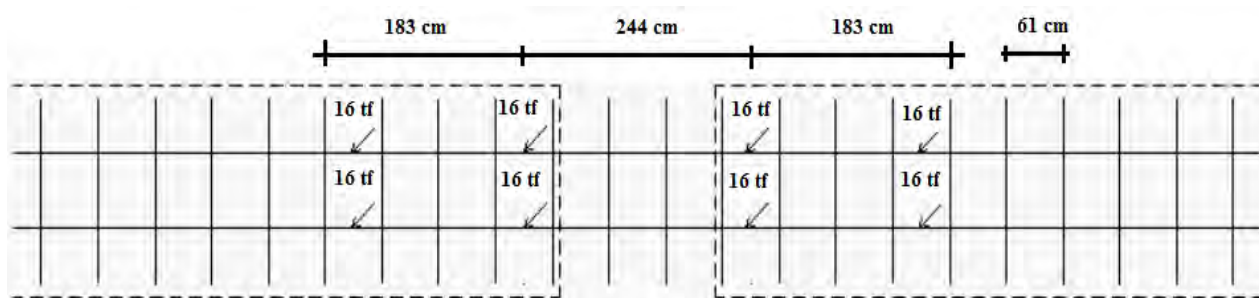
Esquema em planta de 2 vagões GDT com 32 tf/eixo;
